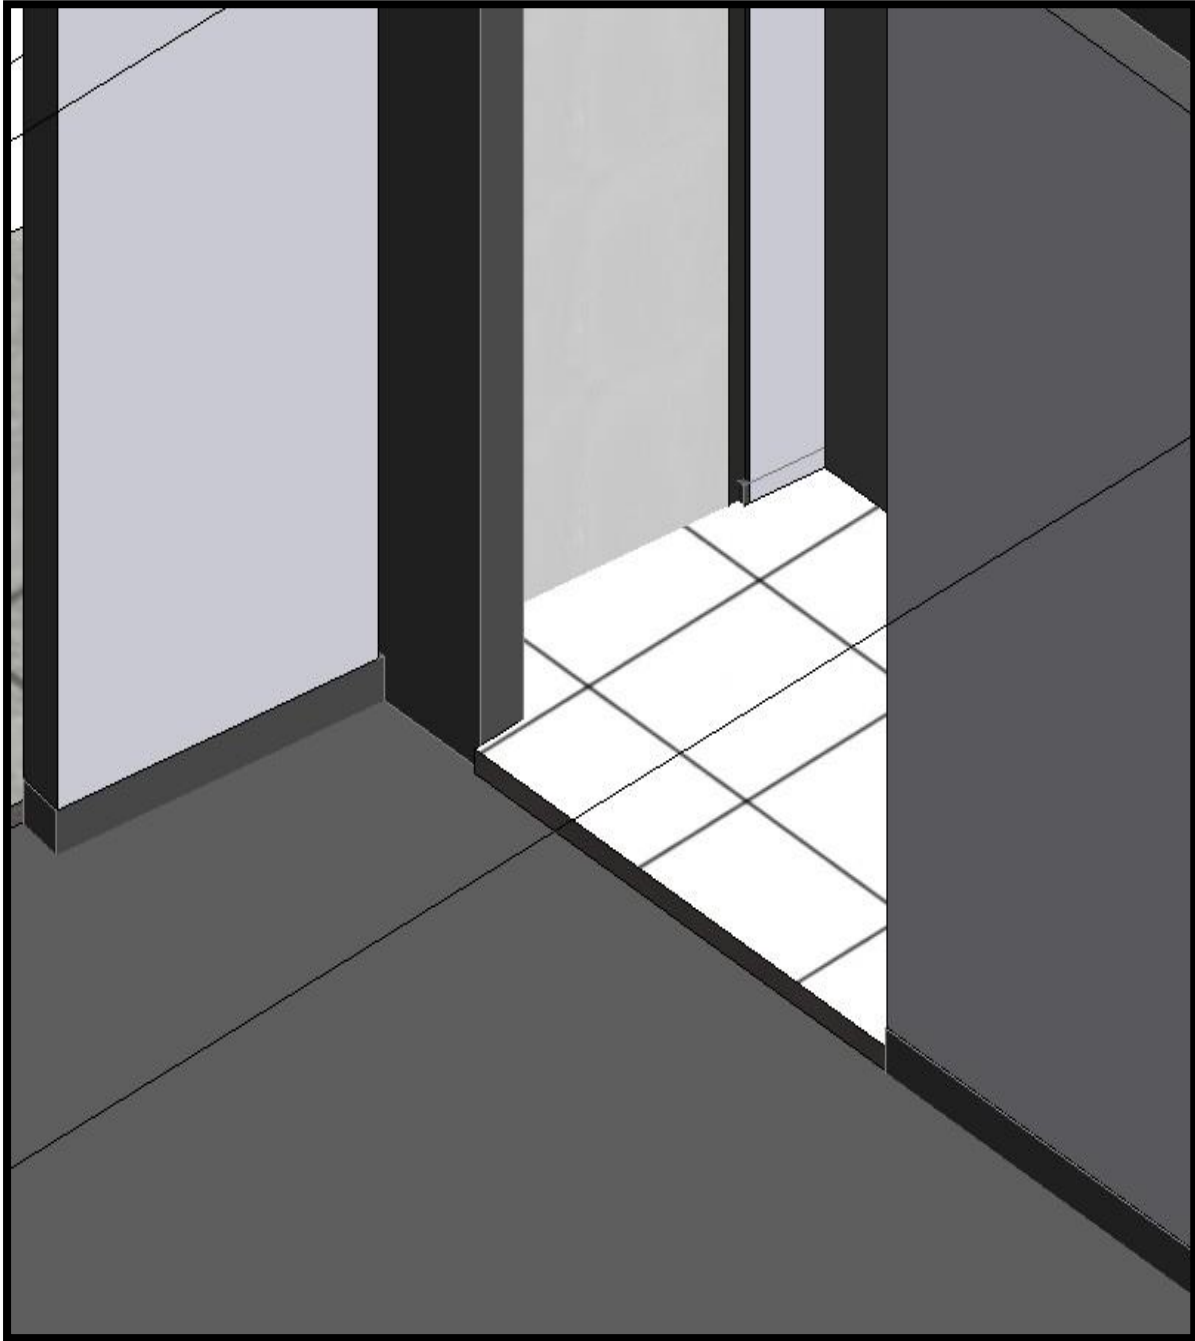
Vista de que no se plantea en planos contrapiso y acabado
